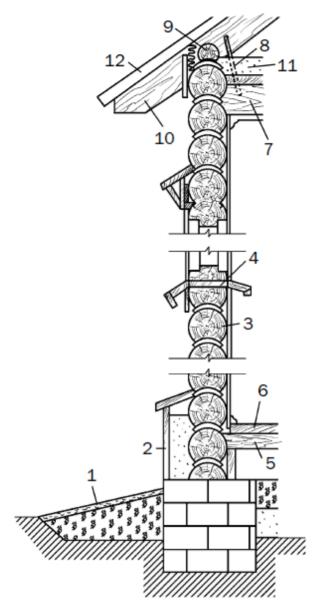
Конструкция рубленой стены: 1 – отмостка; 2 – цоколь; 3 – сруб; 4 – оконный проем; 5 – черный пол; 6 – чистый пол; 7 – балка перекрытия; 8 – скоба; 9 – мауэрлат; 10 – стропило; 11 – засыпка; 12 – кровля
